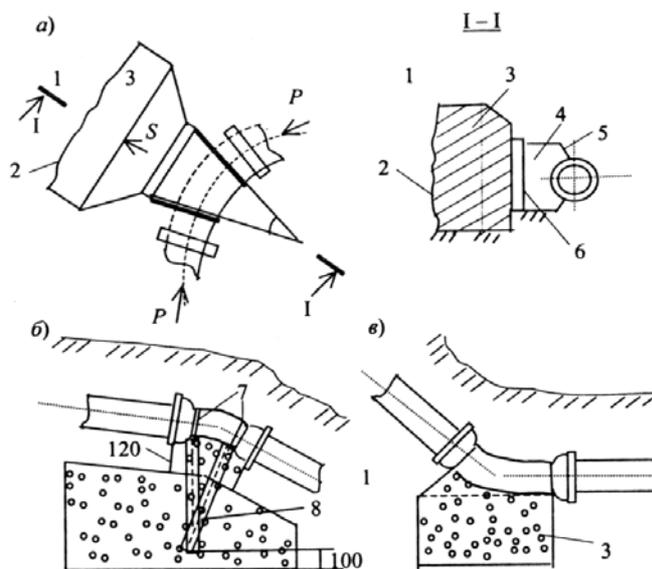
Упоры для чугунных раструбных трубопроводов: *а* – при повороте в горизонтальной плоскости; *б, в* – при повороте в вертикальной плоскости; 1 – ненарушенный грунт; 2 – опорная поверхность; 3 – тело упора; 4 – подушка; 5 – бетон; 6 – толевая прокладка в два слоя; 7 – хомуты; 8 – анкерные болты.
